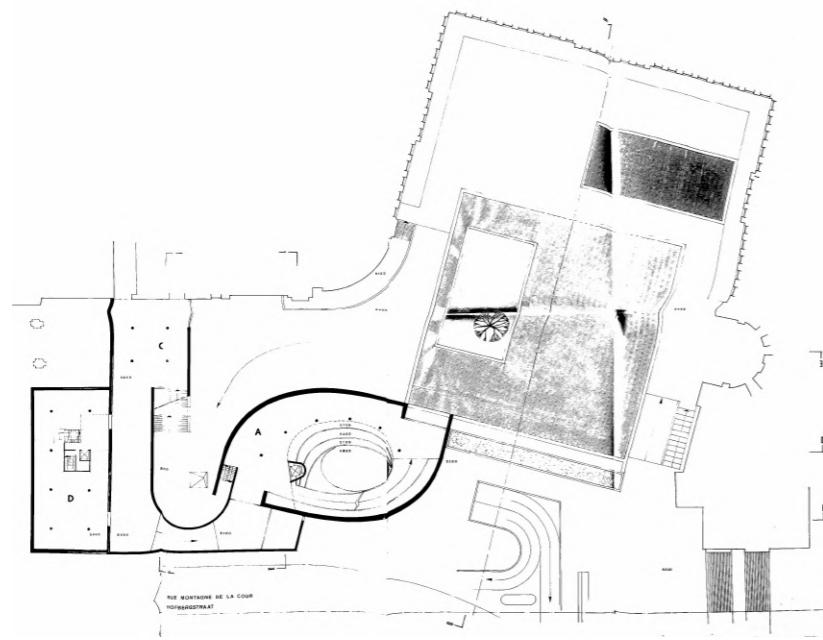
Plan R-1, 5^{ème} esquisse v1.
